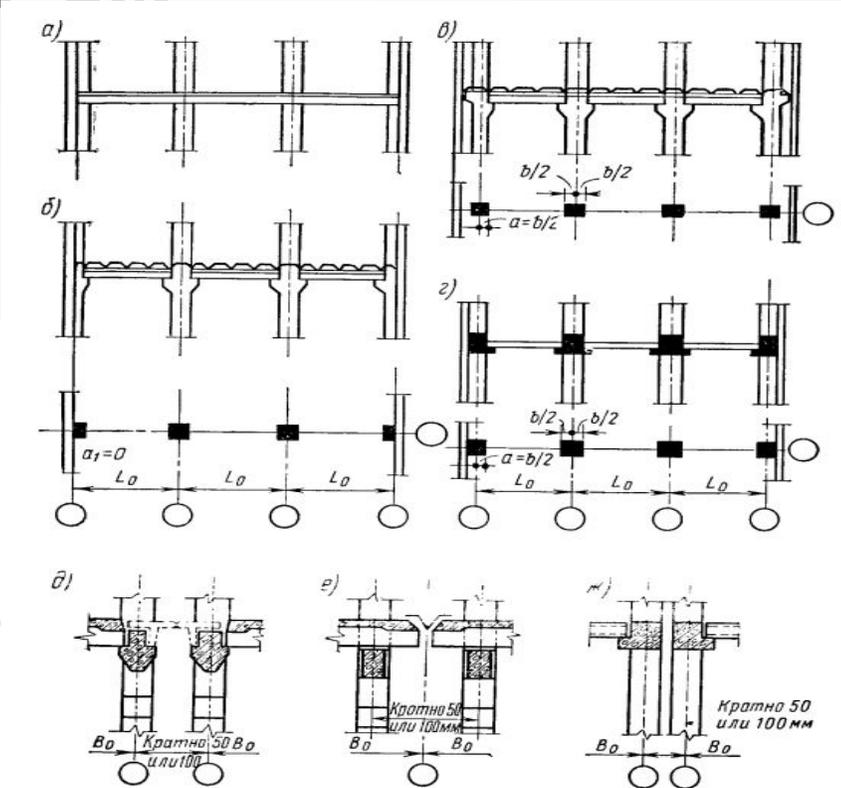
Привязка колонн и стен многоэтажных зданий:
